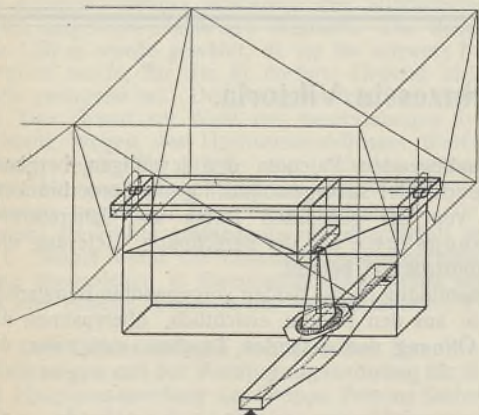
Grundsätzliche Darstellung der Punktlagerung (Baggerseite).
